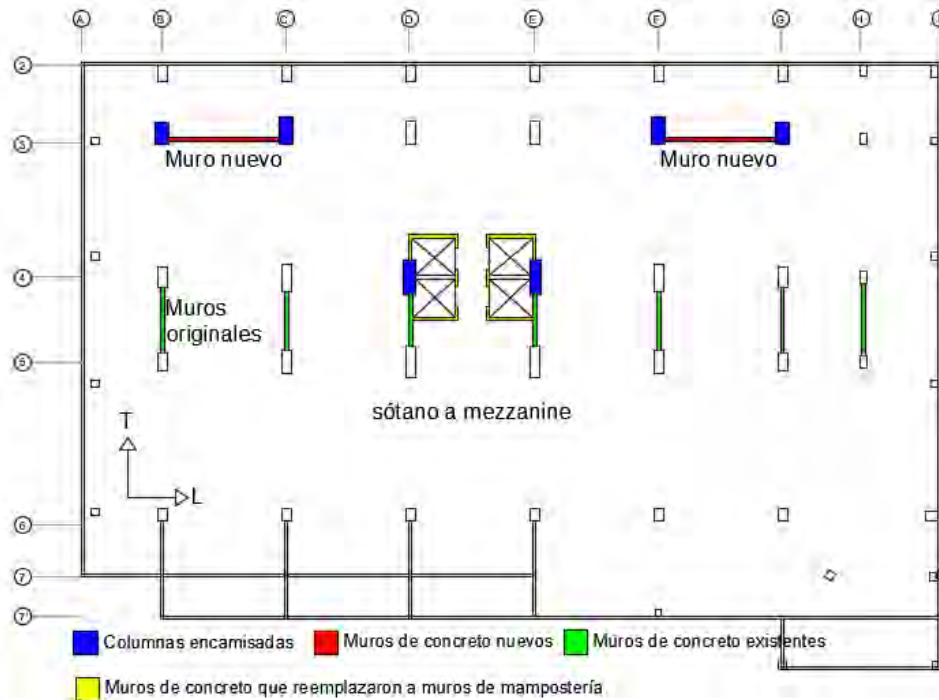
Elementos estructurales reforzados en los niveles del sótano hasta mezzanine
